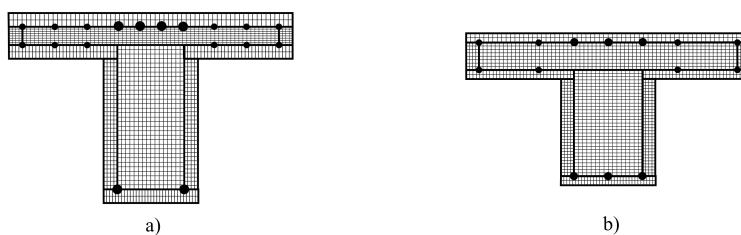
Discretização, em fibras, das secções transversais dos modelos das vigas testadas por a) Gião e b) Muhaj.
